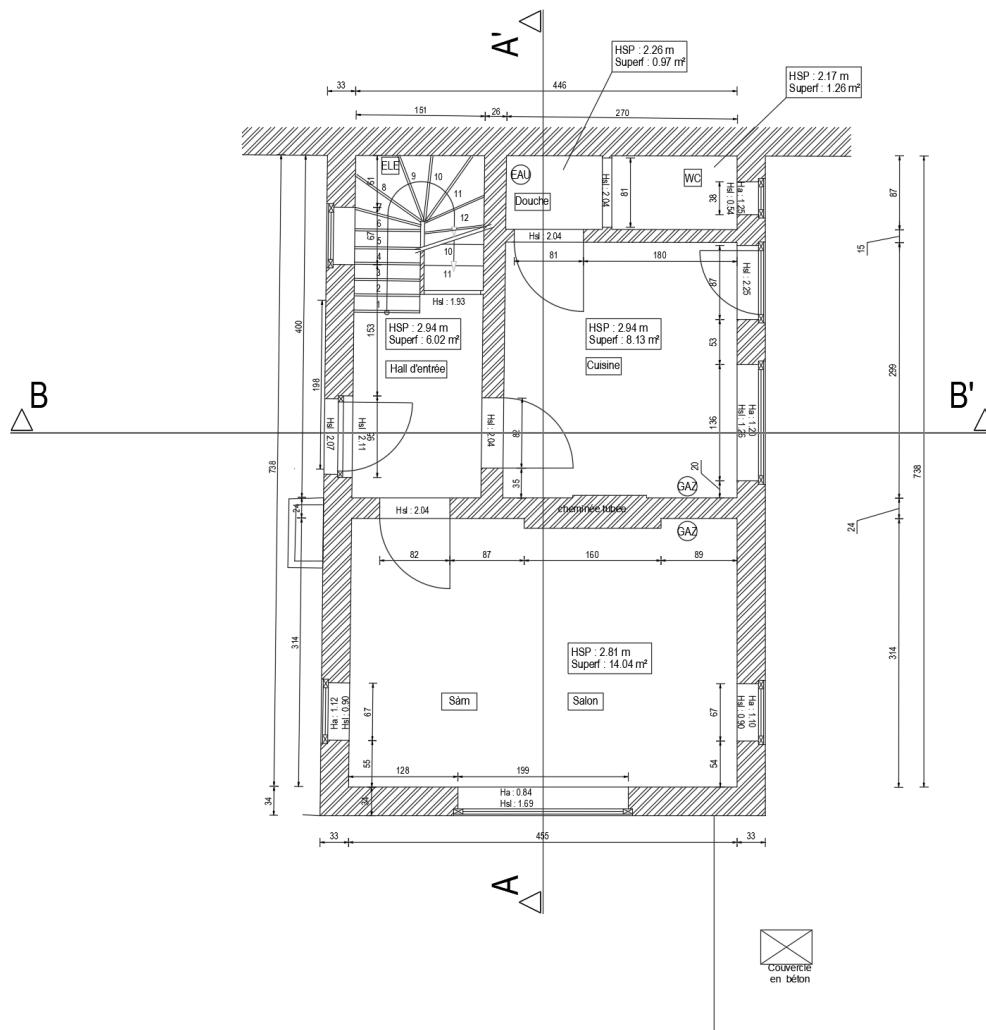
Plan du Rez-de-chaussée du cas d'étude
